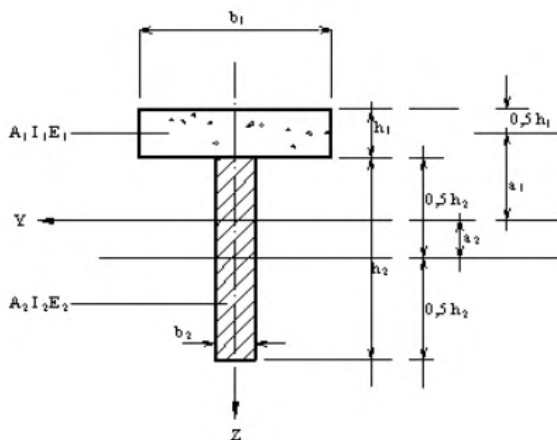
Seção transversal de viga mista concreto/madeira.
